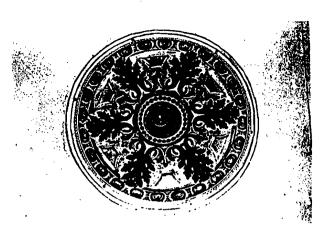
/100317 Detail hiasan plafon di ruang lobby
